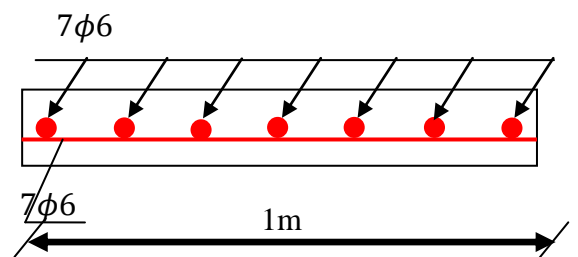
Schéma de ferrailage des poutrelles (commerce)
